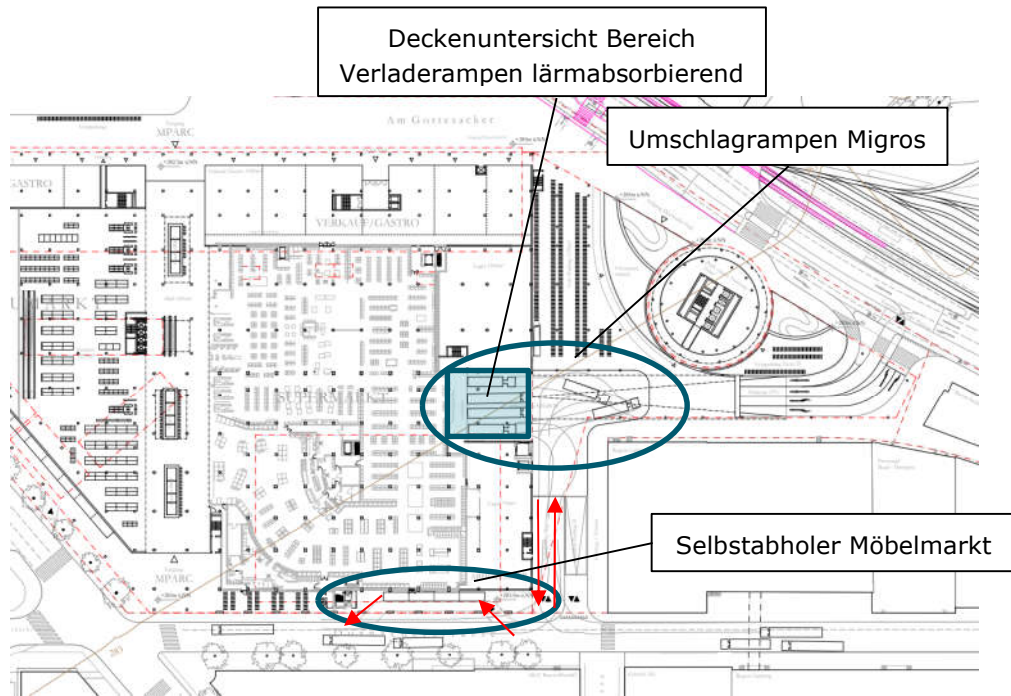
Situation Umschlag Migros (Quelle: Grundriss Erdgeschoss, Herzog & de Meuron 20.05.2019)
